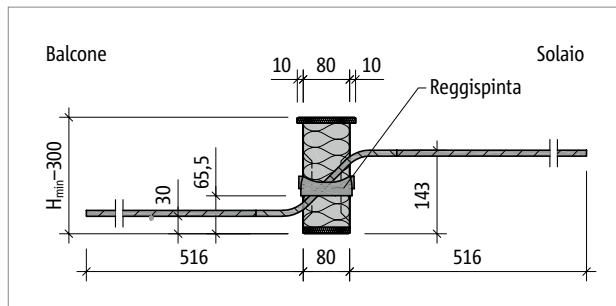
Schöck Isokorb® T tipo QL-V4: sezione del prodotto
